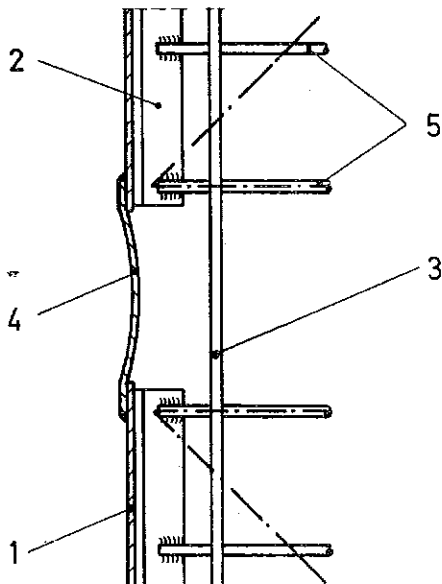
Geschweißte Fundamentanschlüsse
